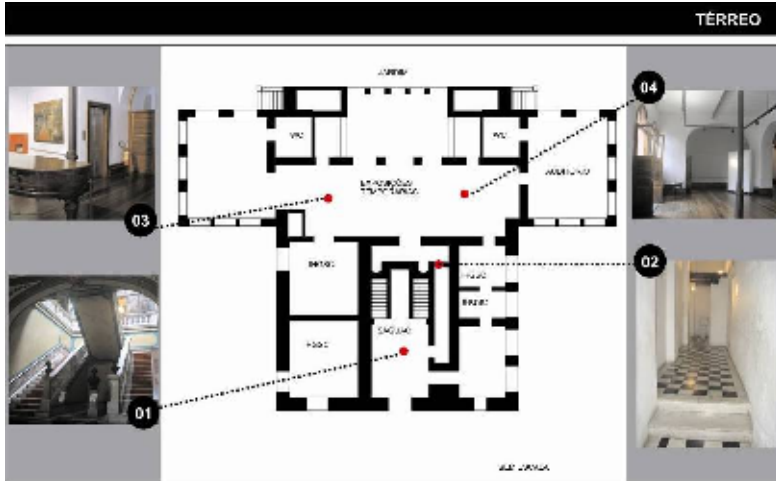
Pavimento térreo. Fonte: Autora (2009).
